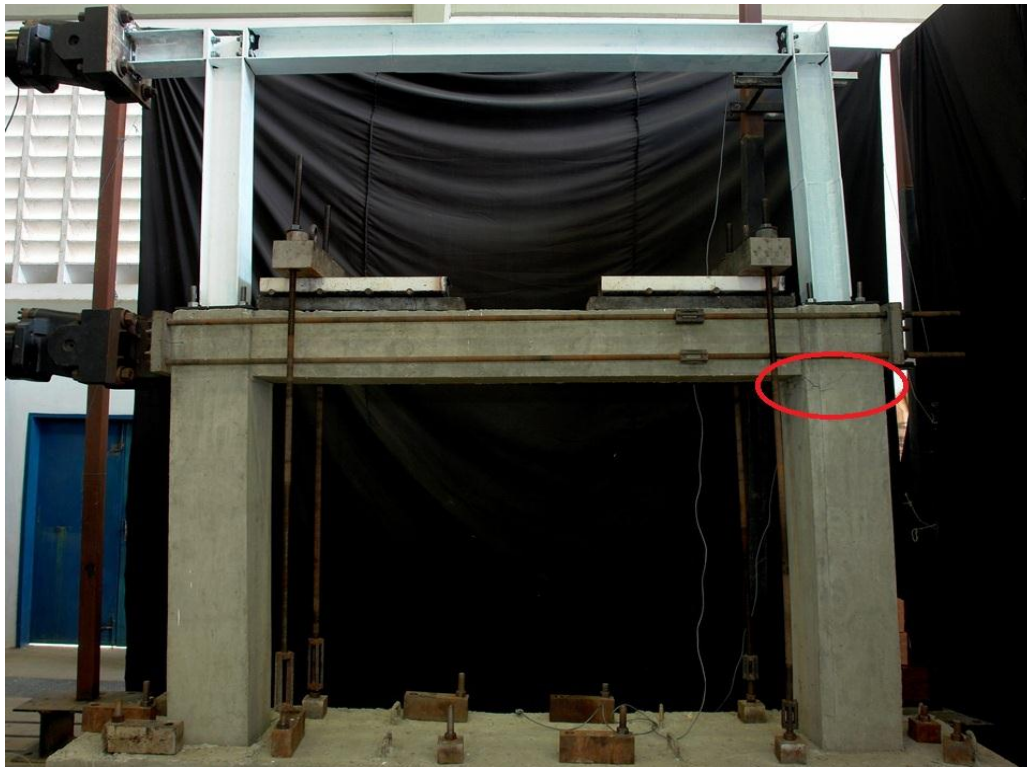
Punto de falla por tracción y corte en columna 2 de hormigón armado
